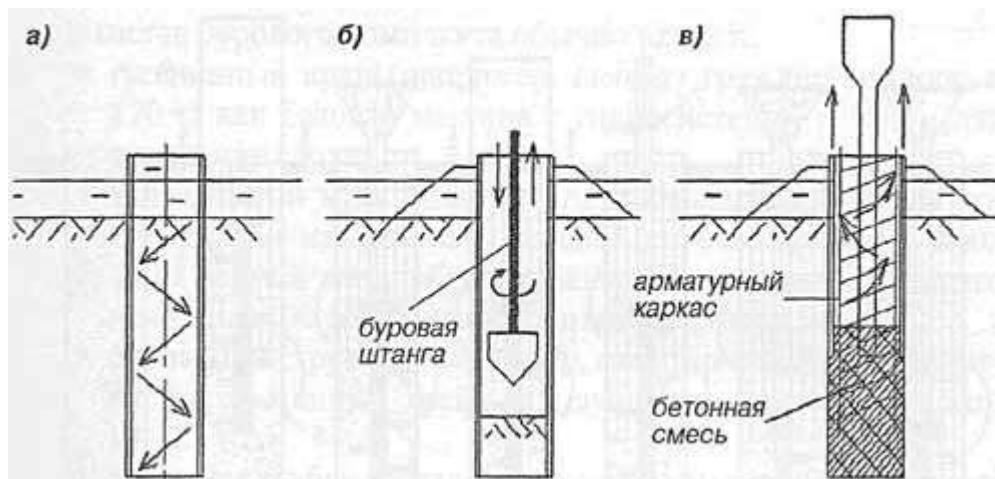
Стадии сооружения буронабивной сваи под защитой обсадной трубы: а – погружение обсадной трубы; б – разработка грунта скважины; в – армирование и бетонирование сваи
